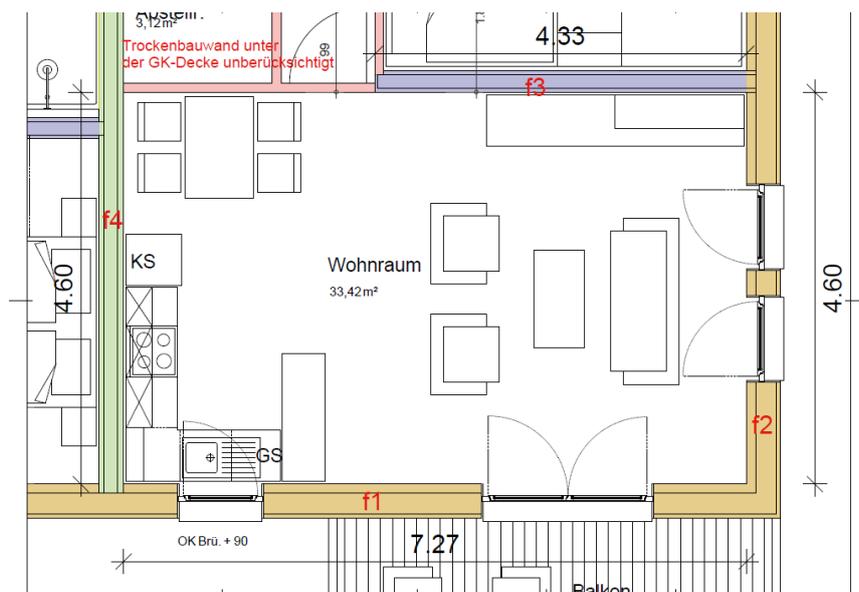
Grundrissssituation 2.OG zu 1.OG (Grundrisse deckungsgleich)
